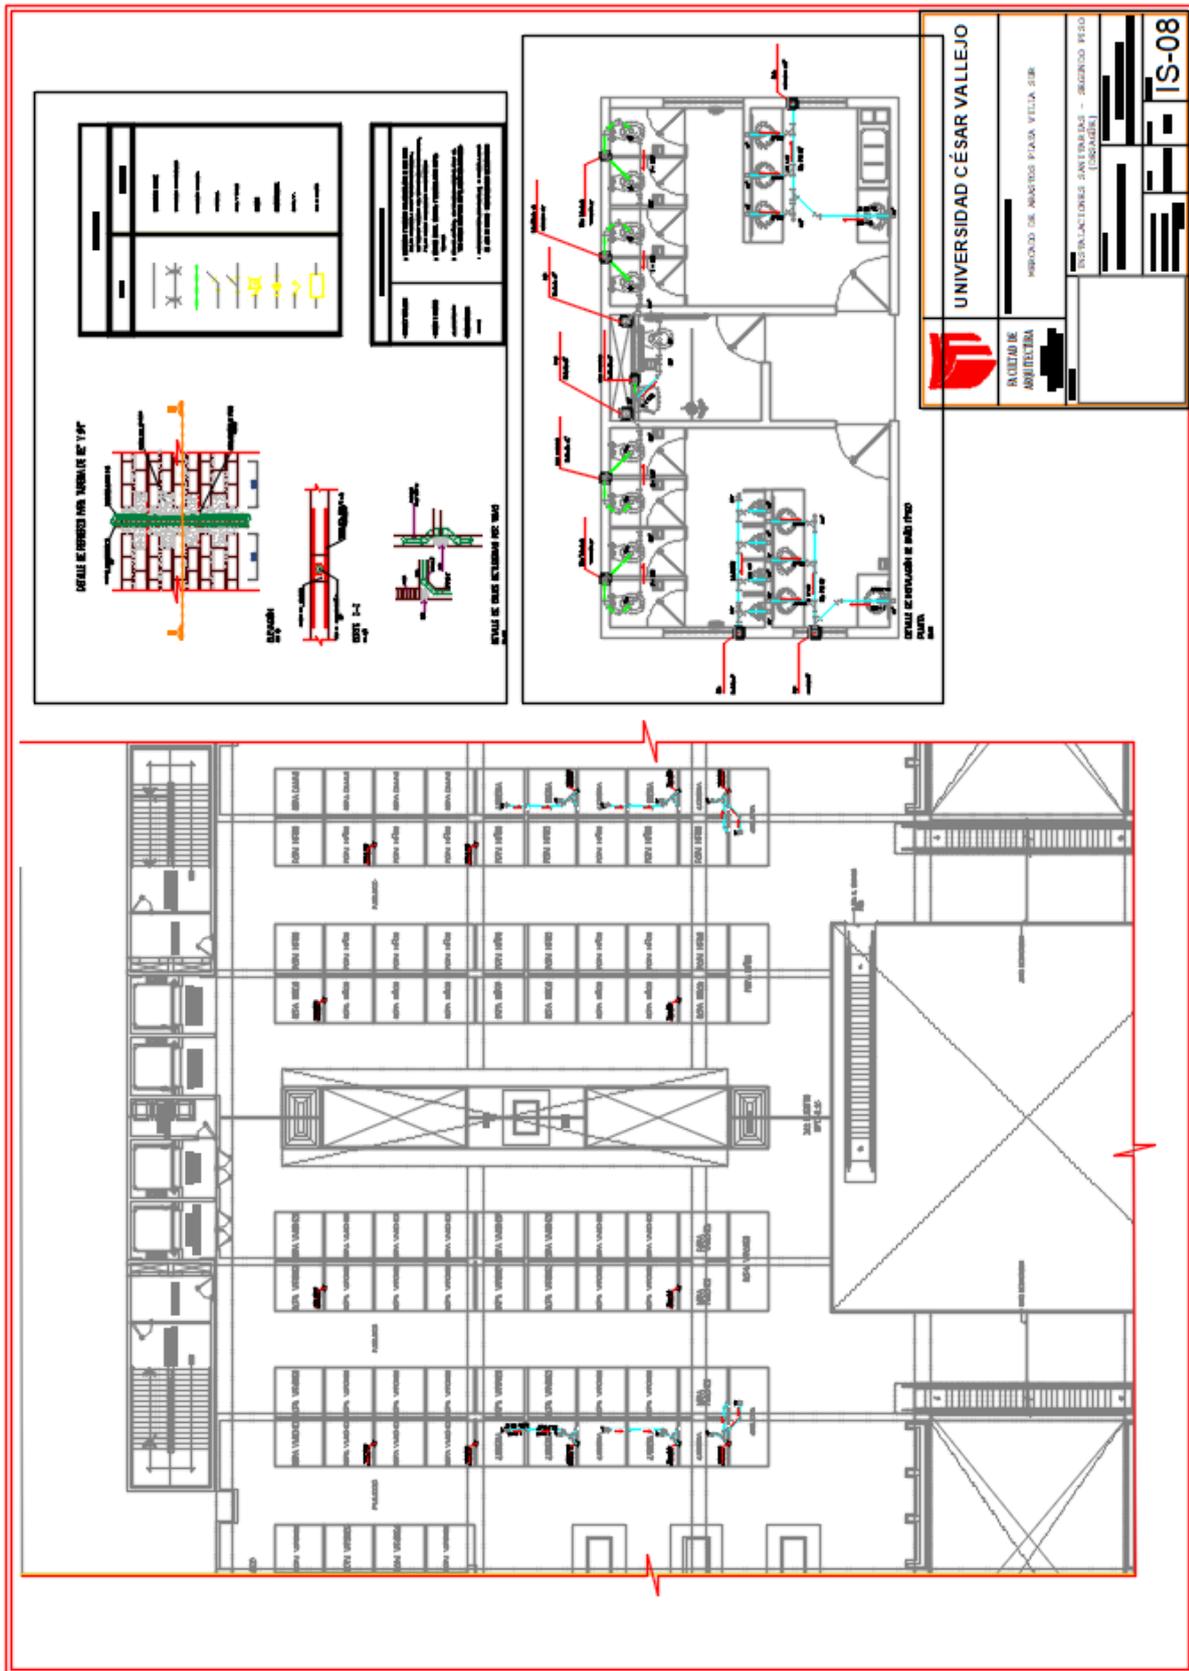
Plano de Sanitarias – Plano de instalaciones de desagüe – segundo piso
